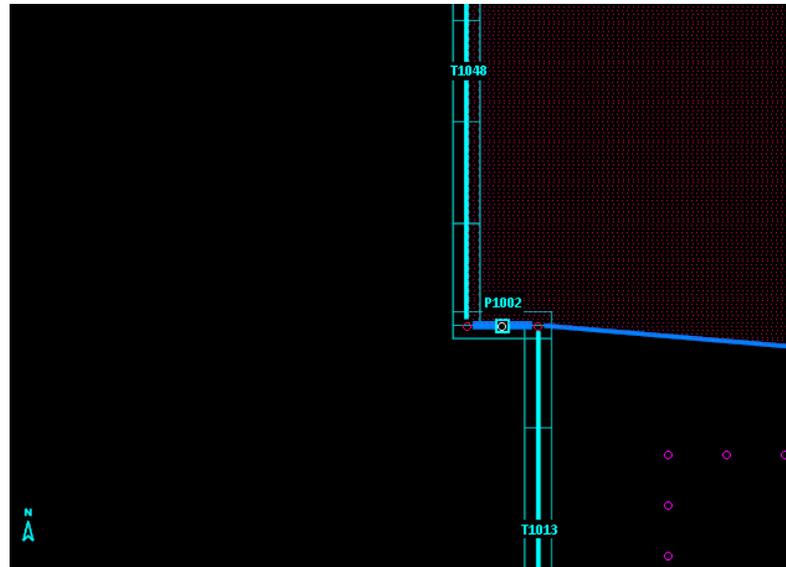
Vista in pianta del disallineamento di due travi, ricollegate al pilastro tramite link rigidi.
